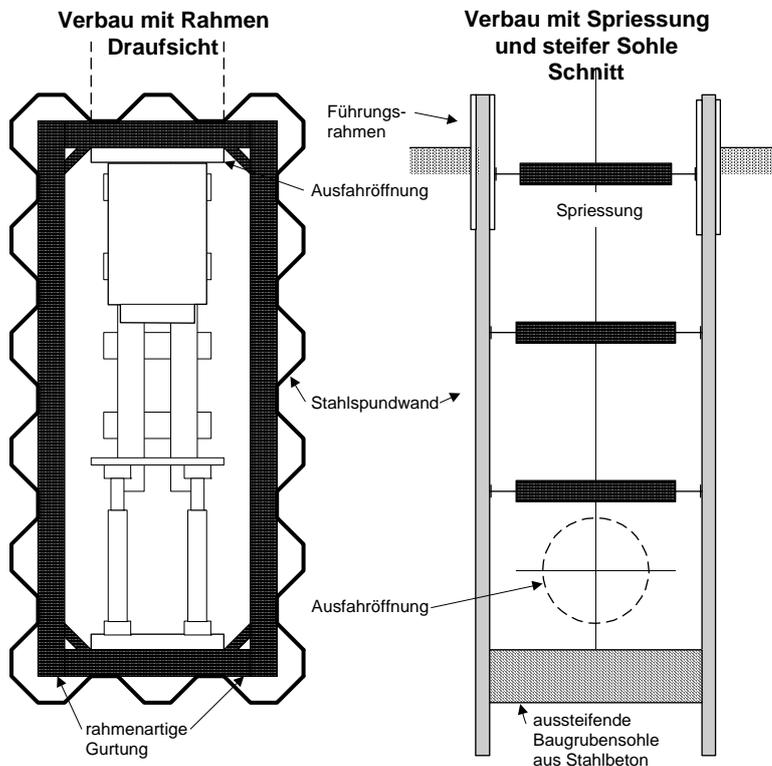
Startbaugrube (mögliche Ausbildung)
